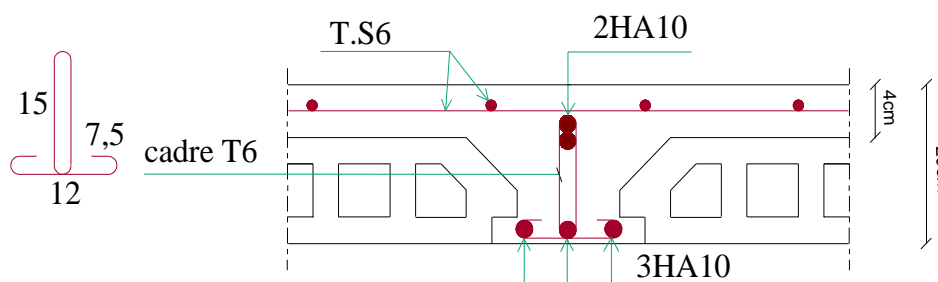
Schéma de ferrailage des poutrelles en appui.
